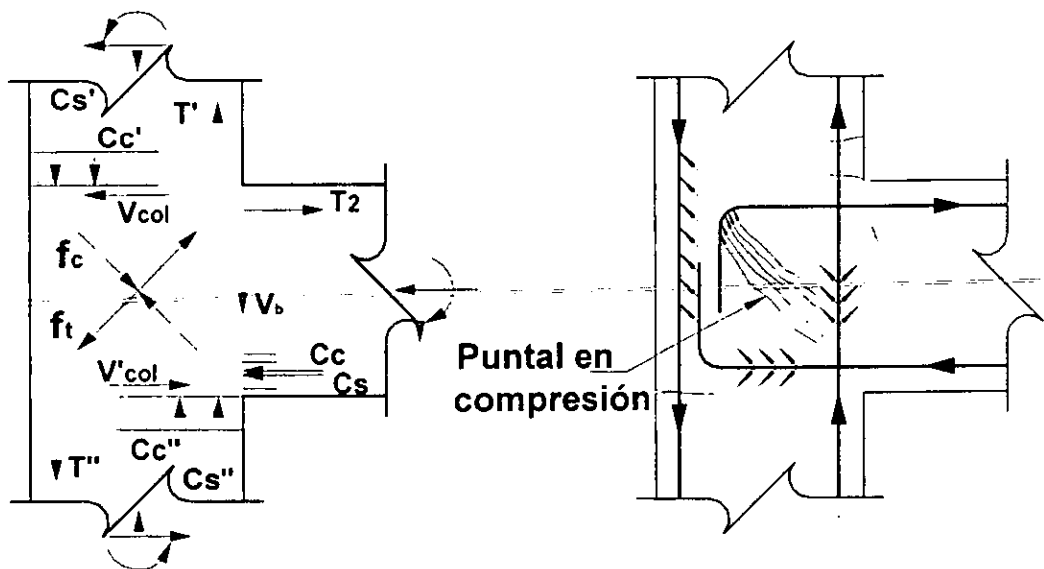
Fuerzas actuando en una conexión plana viga columna [Park y Paulay, 1975]
